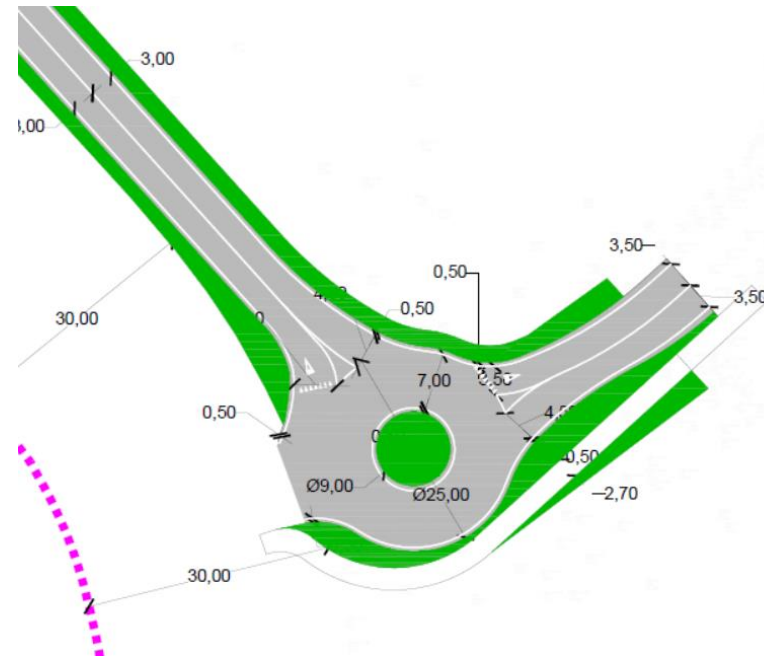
Rotatoria a est dell'Area di intervento – Ipotesi 1 – Planimetria di progetto
